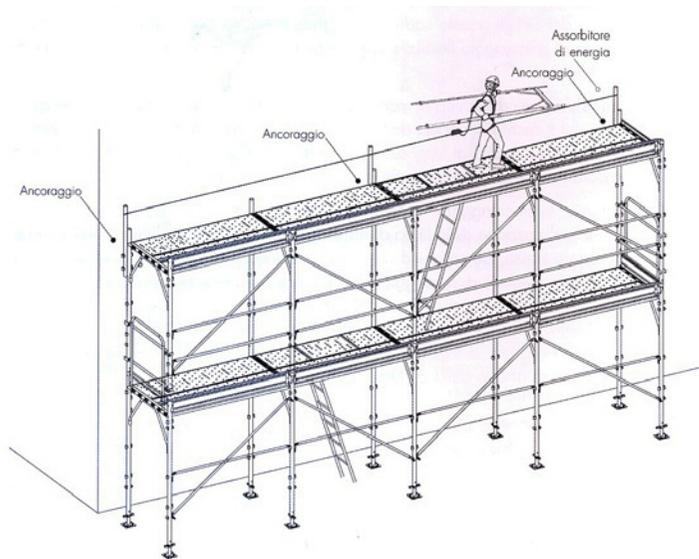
Fase operativa di montaggio del terzo livello: linea di ancoraggio posta ad un livello più elevato rispetto al piano di lavoro
